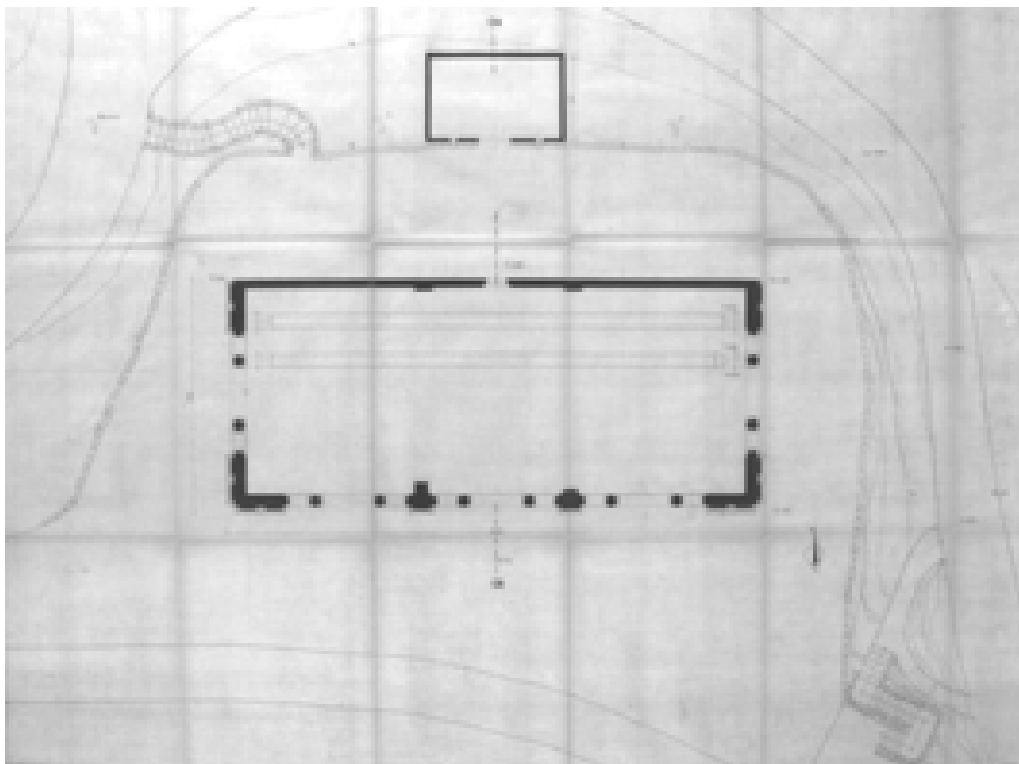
Planimetria dello stato attuale, progetto concessionato il 15/01/1985 (AABS-121)
